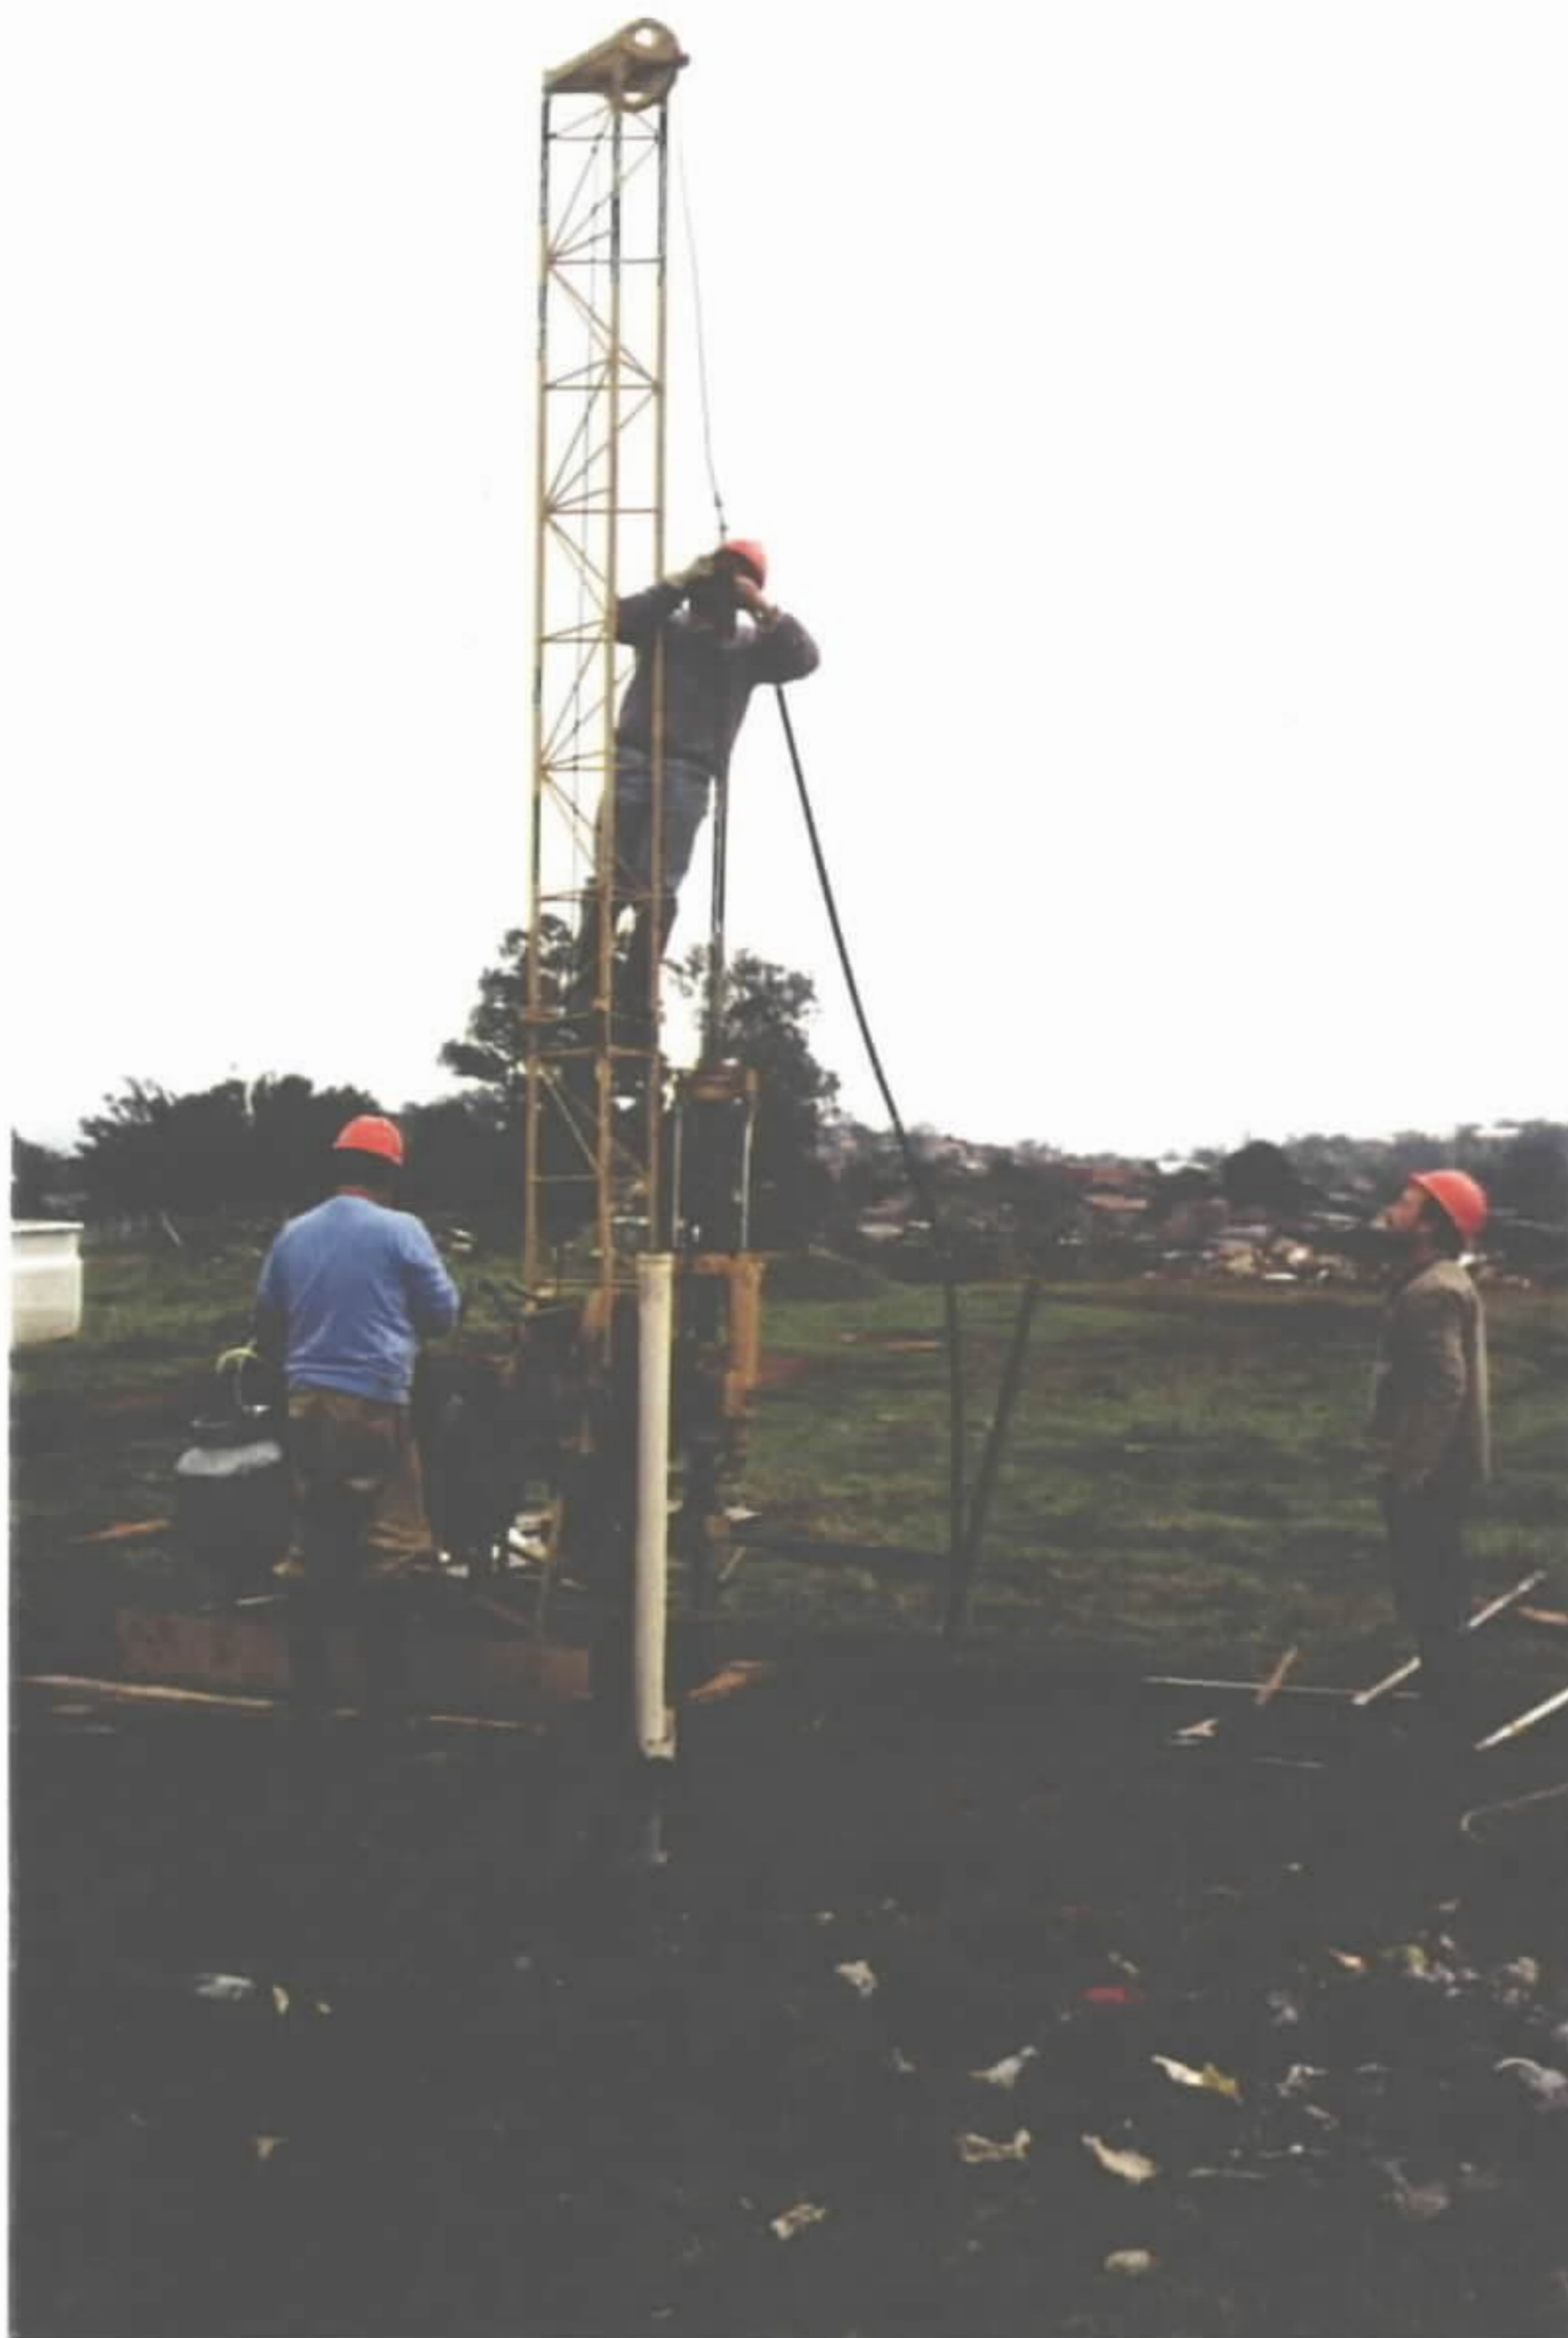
Instalação de revestimento auxiliar em PVC (04 polegadas de diâmetro) durante a perfuração do furo 15 com a sonda rotativa.
